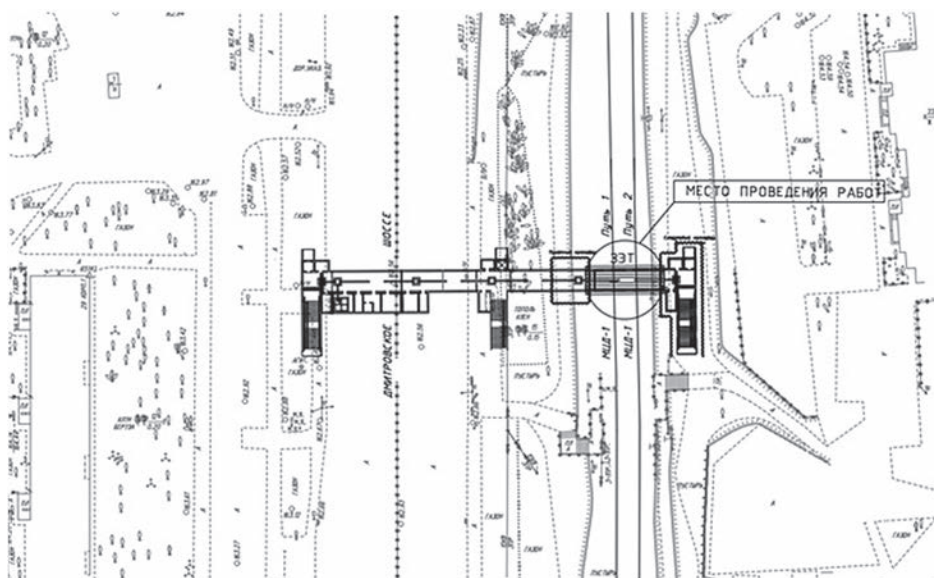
Ситуационный план строительной площадки / Fig. 1. Site plan of the construction area
